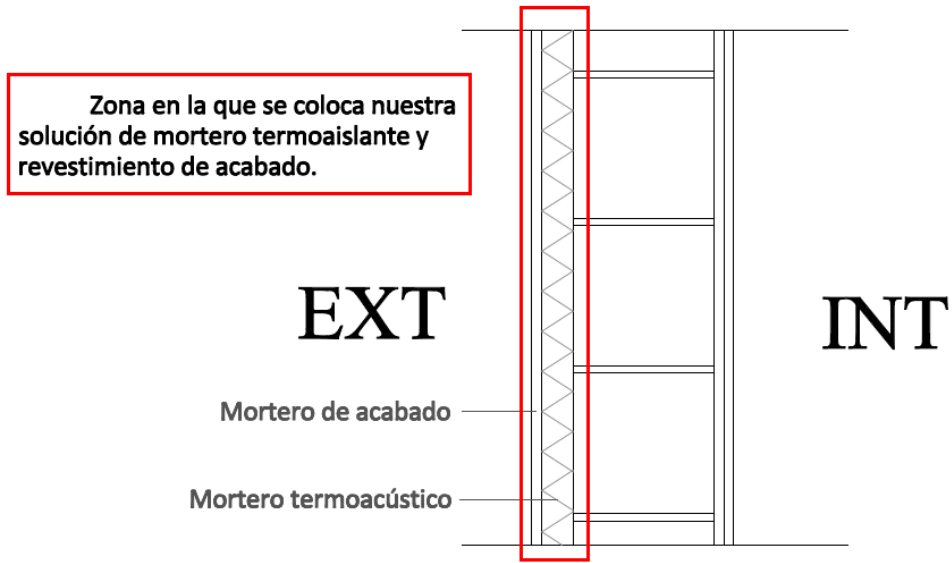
Detalle solución exterior con mortero termoaislante sobre bloque.
